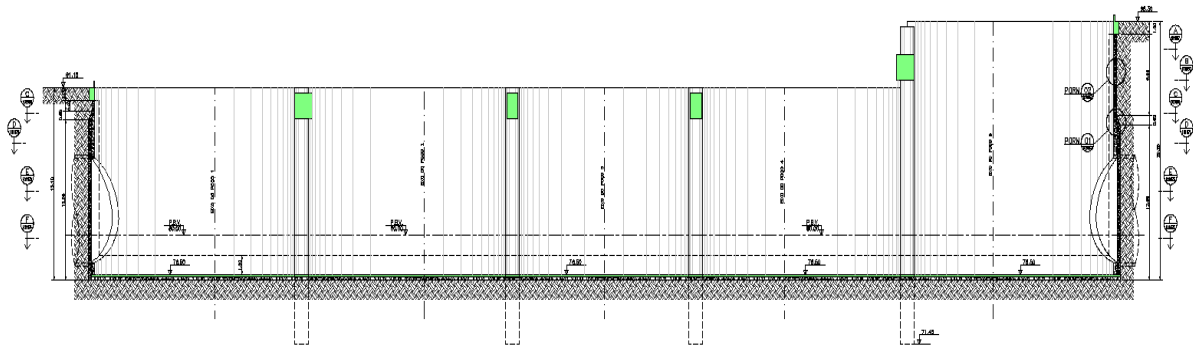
Corte transversal dos poços da estação (adaptado TF, 2011).
